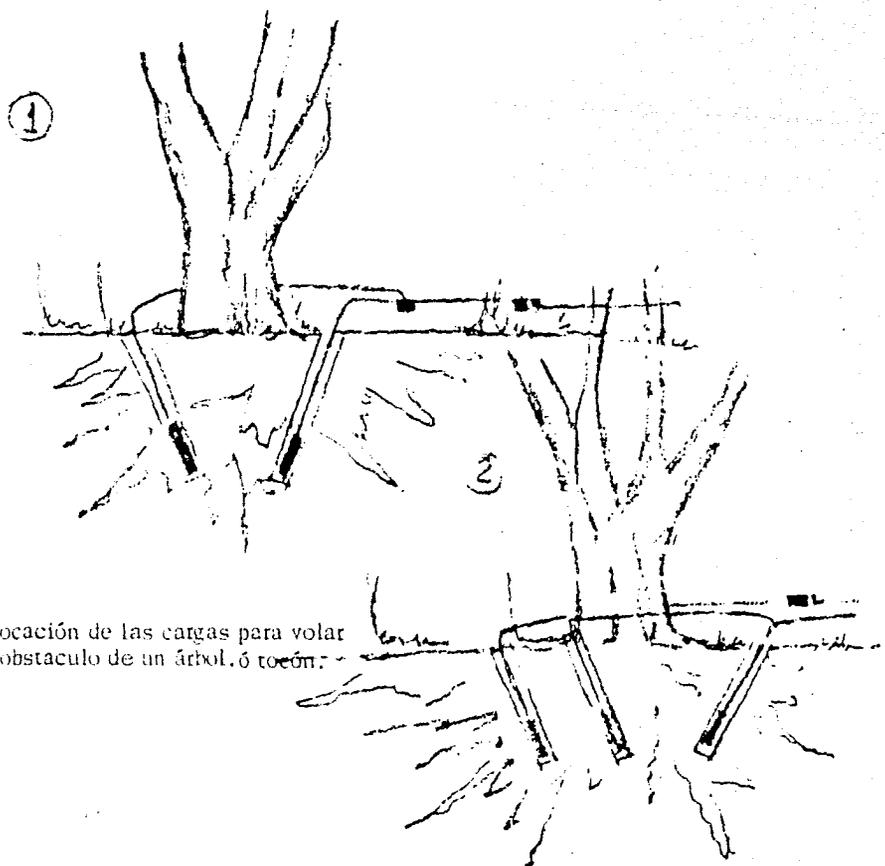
Colocación de las cargas para volar un obstaculo de un árbol, ó tocón.
